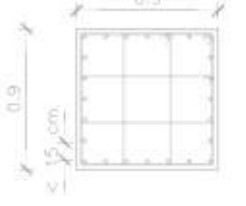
Armado Columnas interiores edificio de 10 pisos
